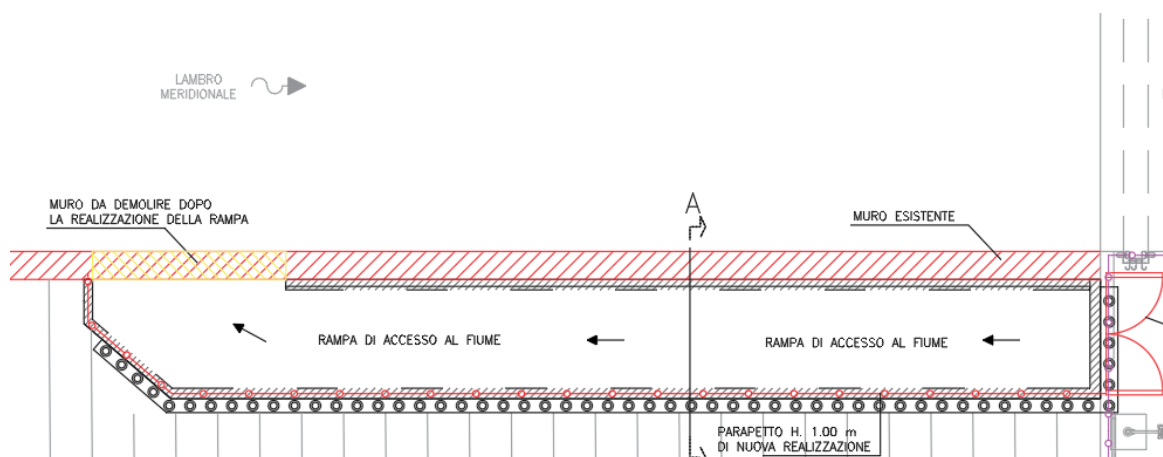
Planimetria rampa di accesso al deviatore Fiume Olona
